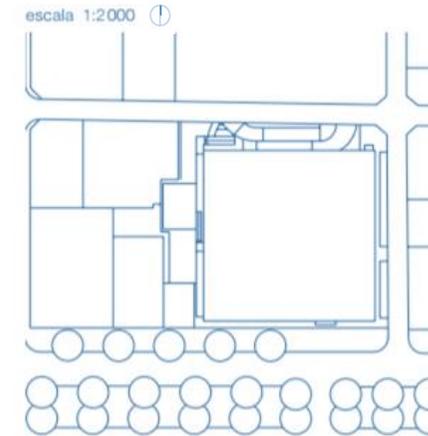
Planta de emplazamiento de la Mediateca de Sendai.
